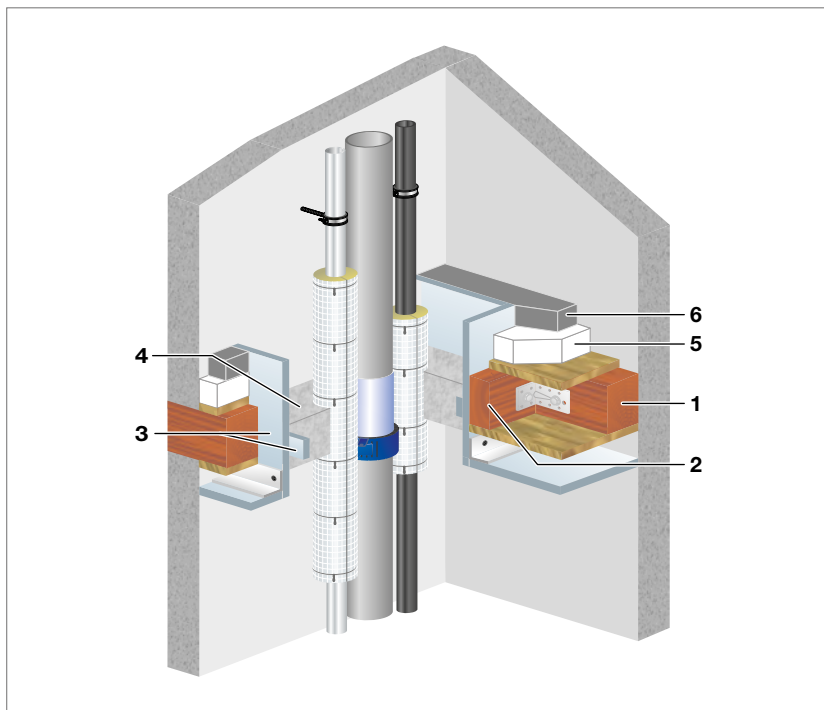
Holzbalkendecke mit Unterdecke „F 90“-Konstruktion
